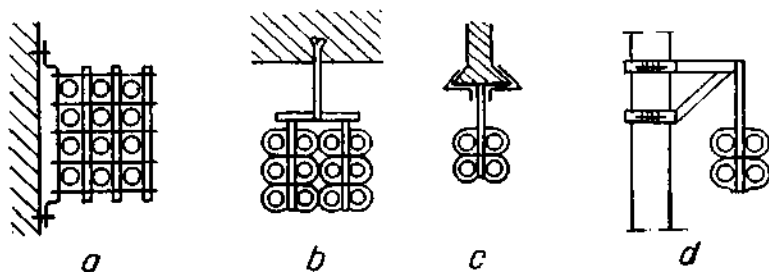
Exemple de execuție a instalațiilor în țevi autoportante :
